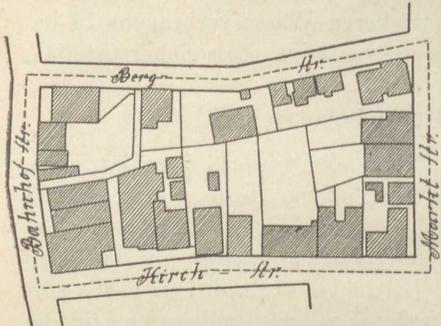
Baublock zur Ermittlung des durchschnittlichen Versickerungswertes.
